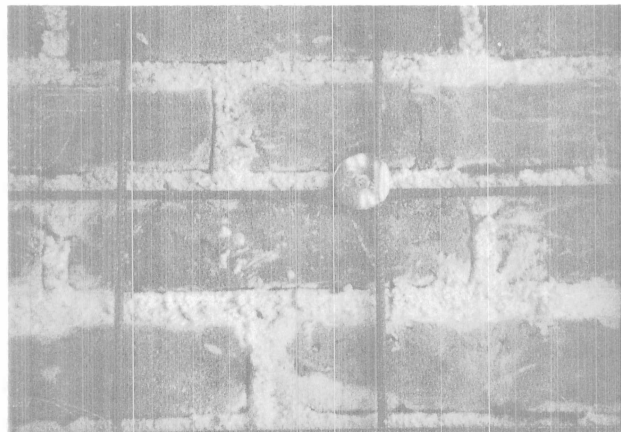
Malla metálica anclada a un muro de mampostería con fijadores *Hilti
